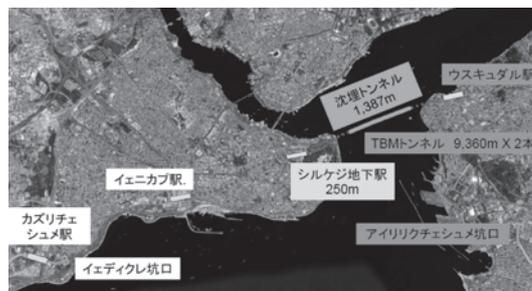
ボスポラス海峡横断鉄道建設 平面ルート図
